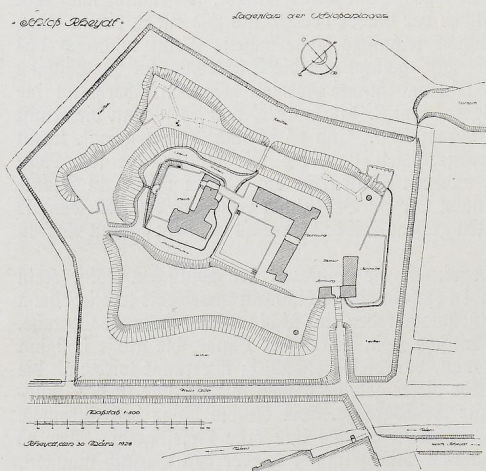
Schloß Rheydt, Lageplan 1:5000.
